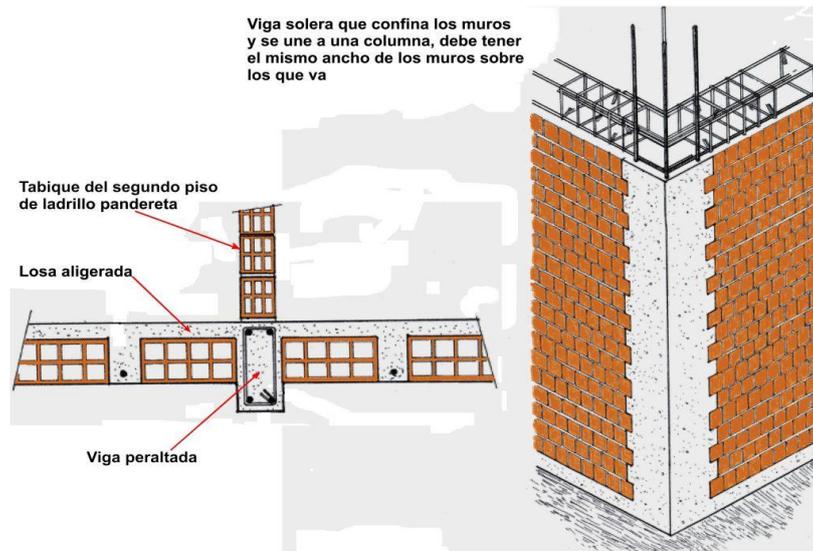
Vigas soleras en albañilería confinada. (Rojas R.)
